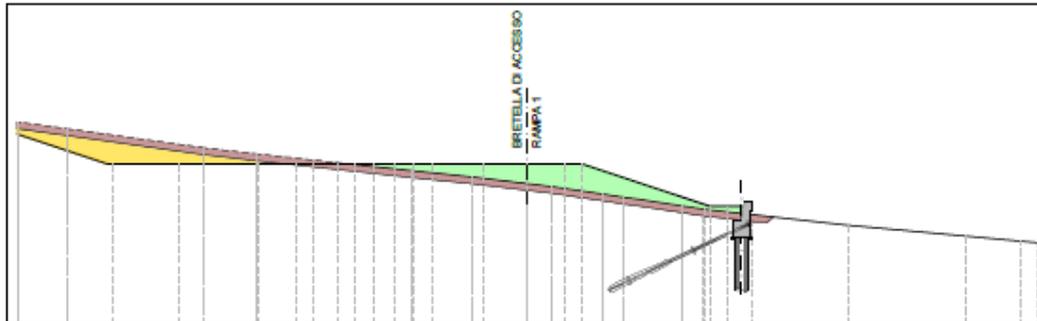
Sezione trasversale della rampa di accesso con evidenza delle opere di sostegno da elaborato di progetto
